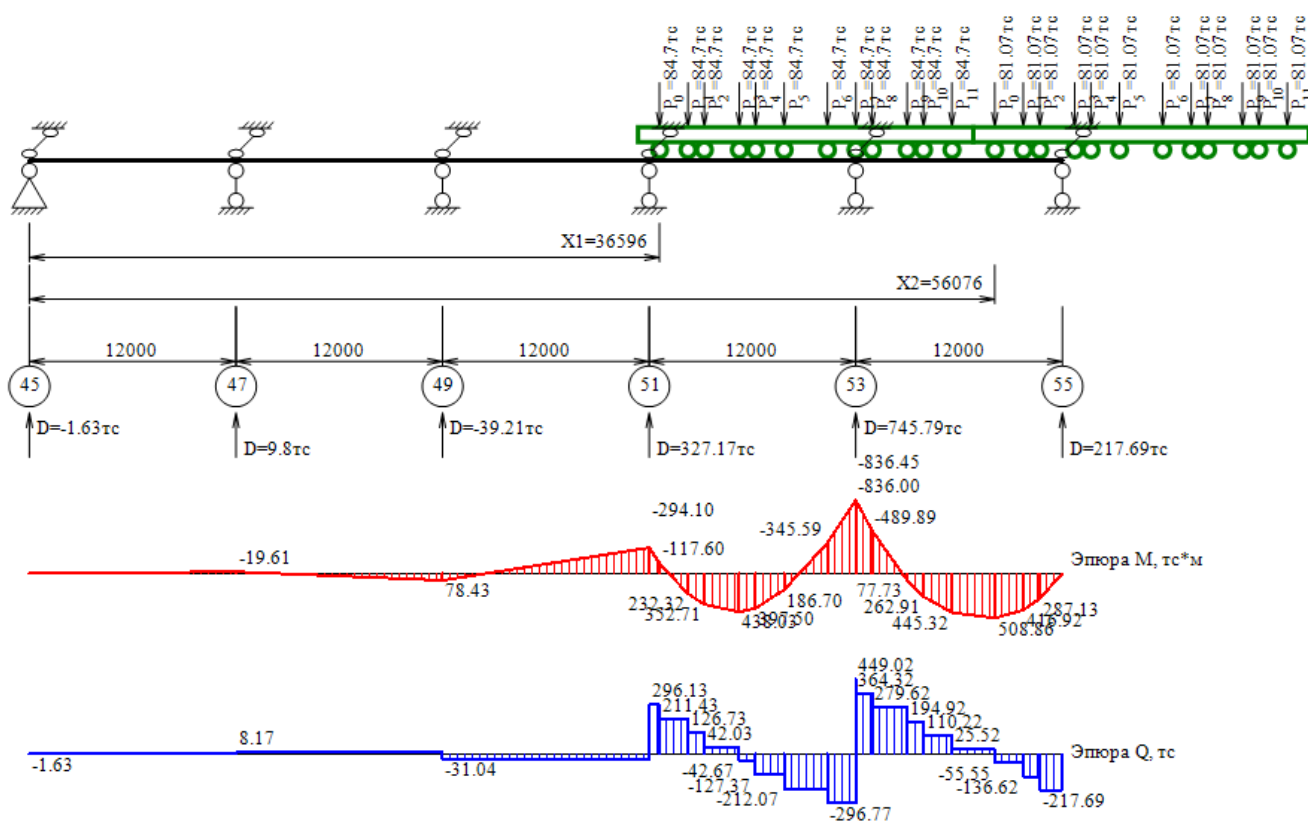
Эпюры усилий M_x и Q от вертикальной нагрузки при расчетном положении кранов, соответствующему максимальной поперечной силе, воспринимаемой стенкой
